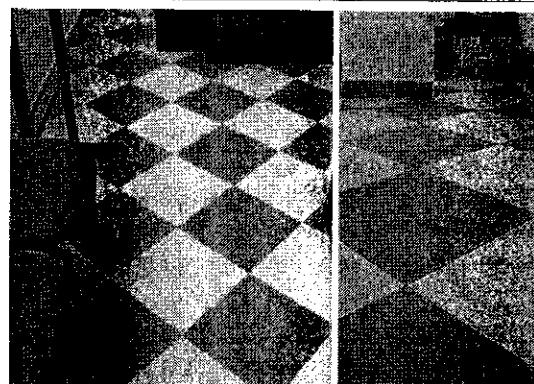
Afectación en acabados de piso en el eje de inicio de los voladizos, presencia de fisuras
